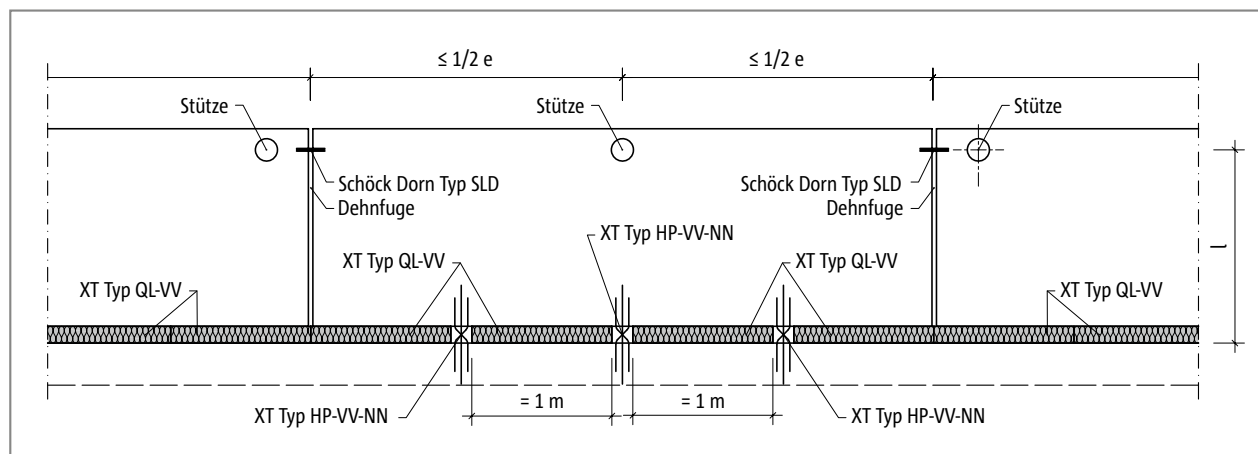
Schöck Isokorb® XT Typ HP: Dehnfugenanordnung
